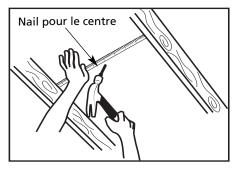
Mettez un clou de passer par le panneau de toiture comme un point central
